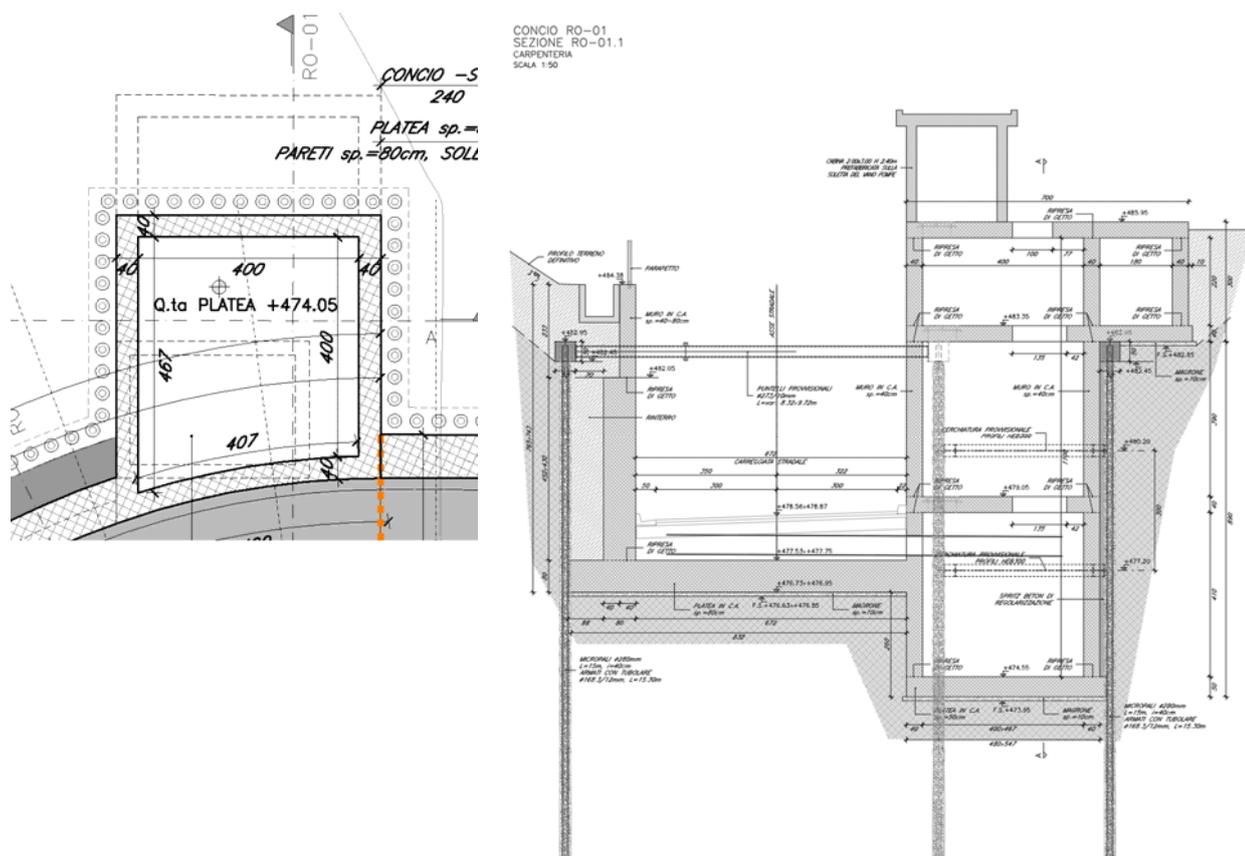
Pianta e sezioni trasversale pozzetto
